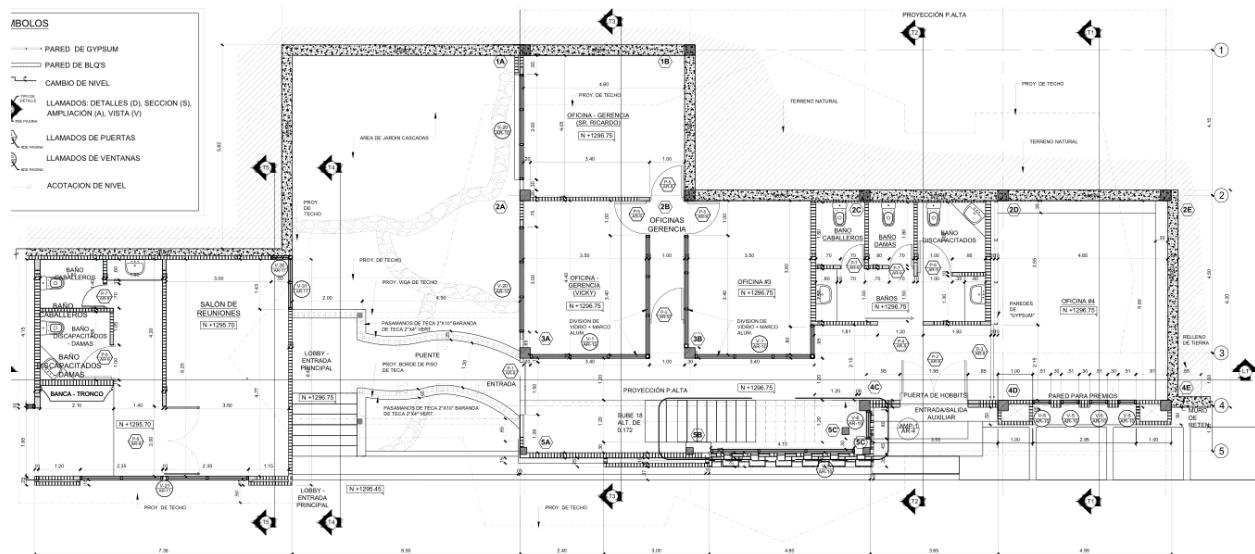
Planta arquitectónica nivel 100 – Edificio Gerencia / Cupping
